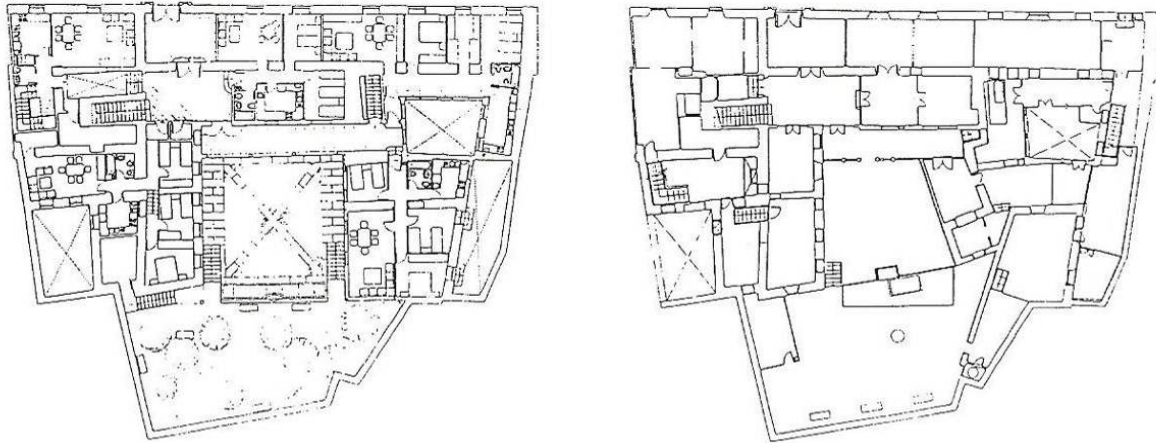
Palacio de Villarreal. Planta baja. Estado anterior y reformado (Martín Clabo y Tajuelo Sánchez, 1998).
